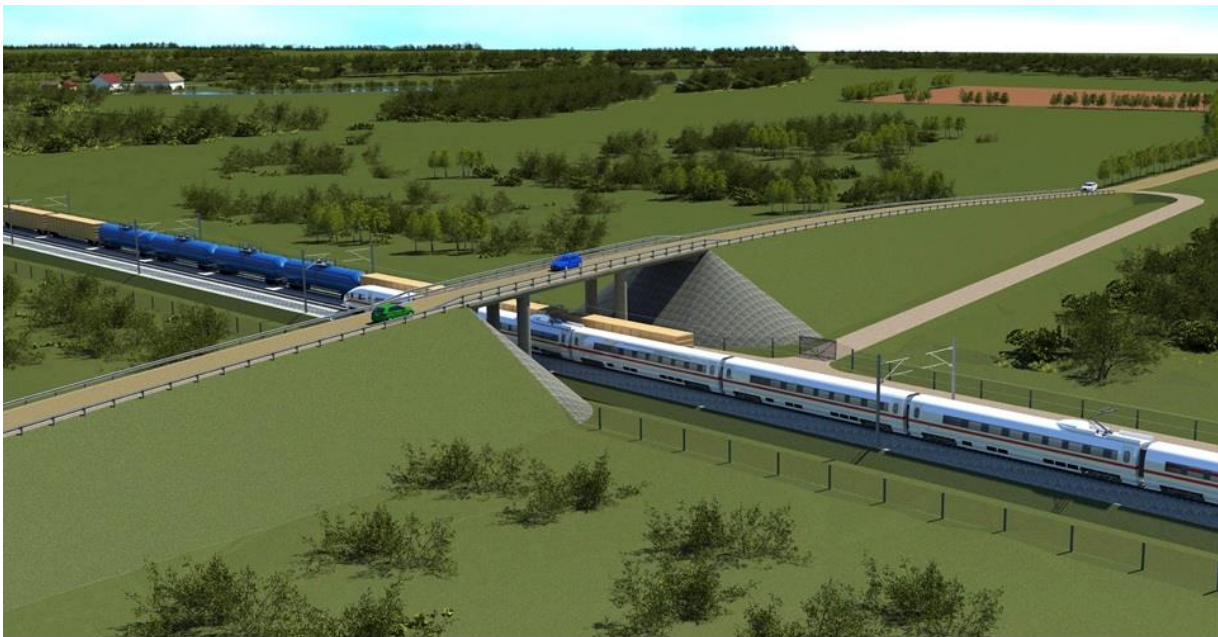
Viadukt üle raudtee (Rail Baltic Info, 2013)
